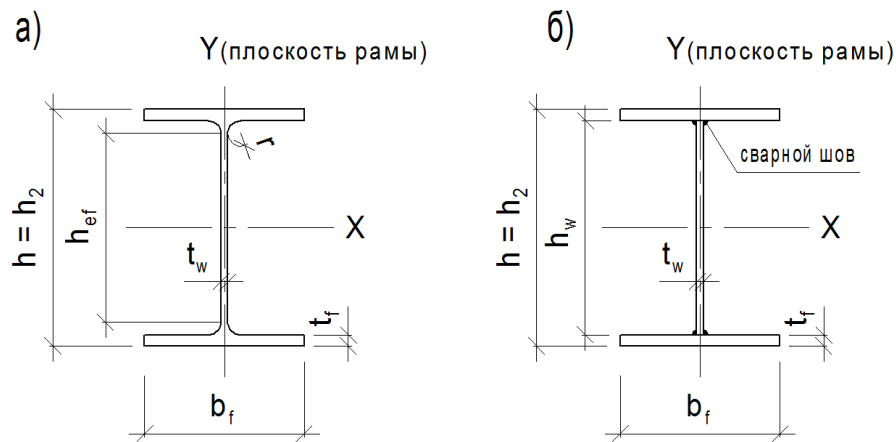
Сечение верхней части колонны: а – прокатное; б – сварное.
